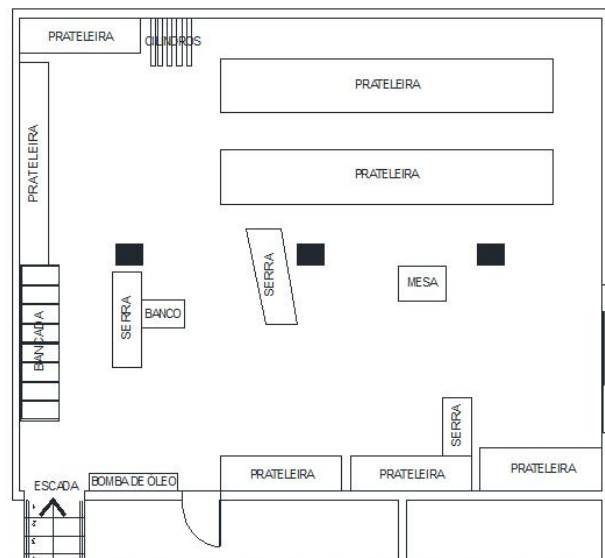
PLANTA BAIXA *LAYOUT* DO ESTOQUE ANTERIOR AO TRABALHO
